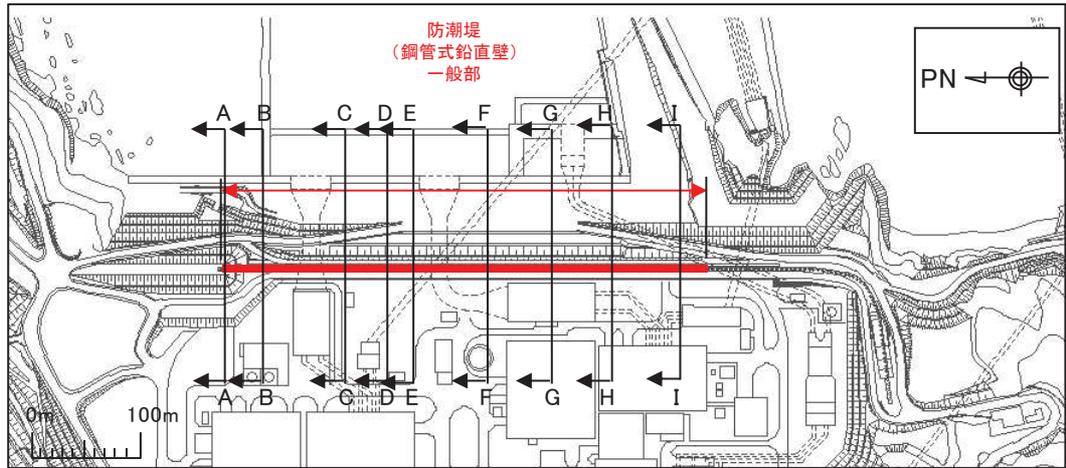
鋼管式鉛直壁（一般部）平面配置図
